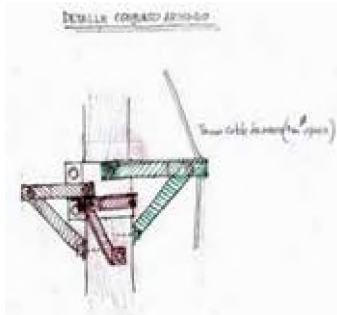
Detalle en tres dimensiones del puntal, rótula y fundación (fuente: cátedra de Estructuras III, FAU-UNNE)
